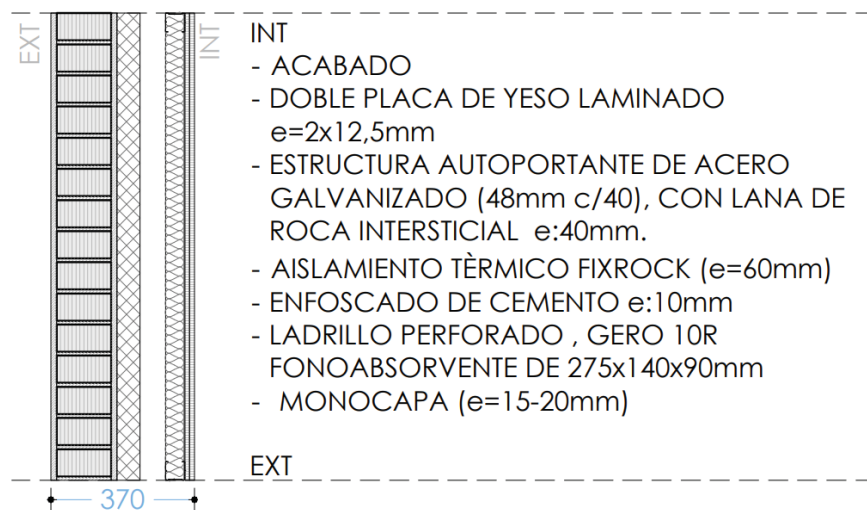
Esquema de la fachada Este de las viviendas original del edificio.
